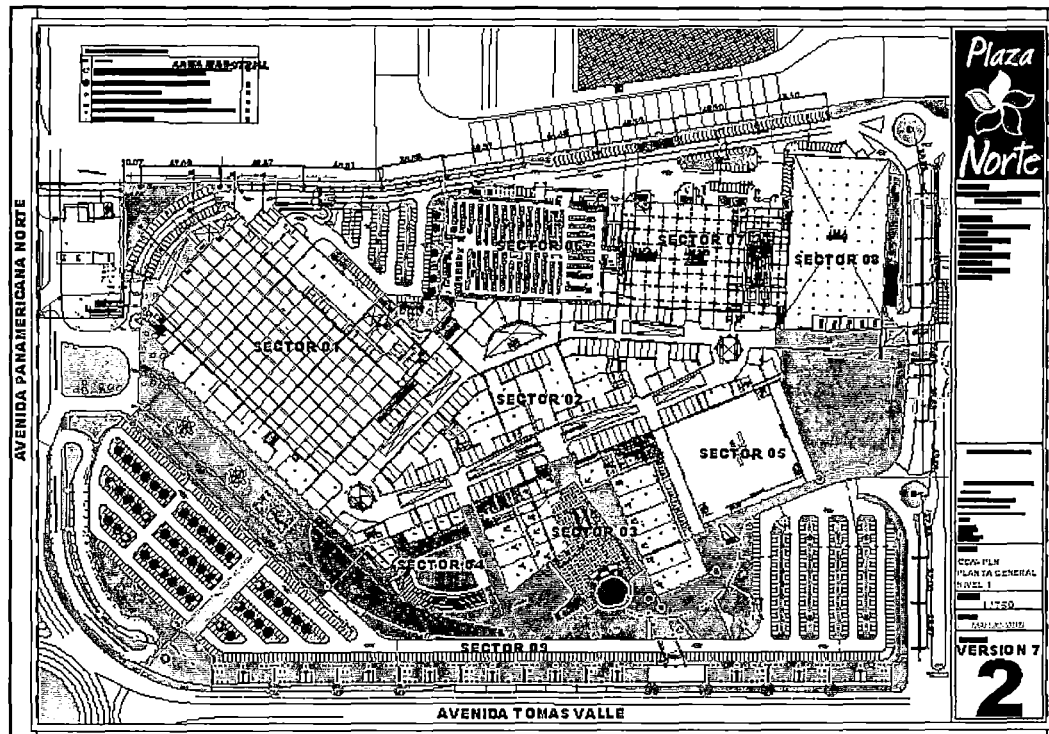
VISTA DE LOS SECTORES DEL PROYECTO. EL SECTOR 10 TERRAPUERTO, NO APARECE EN LA PLANTA DEL PROYECTO.
